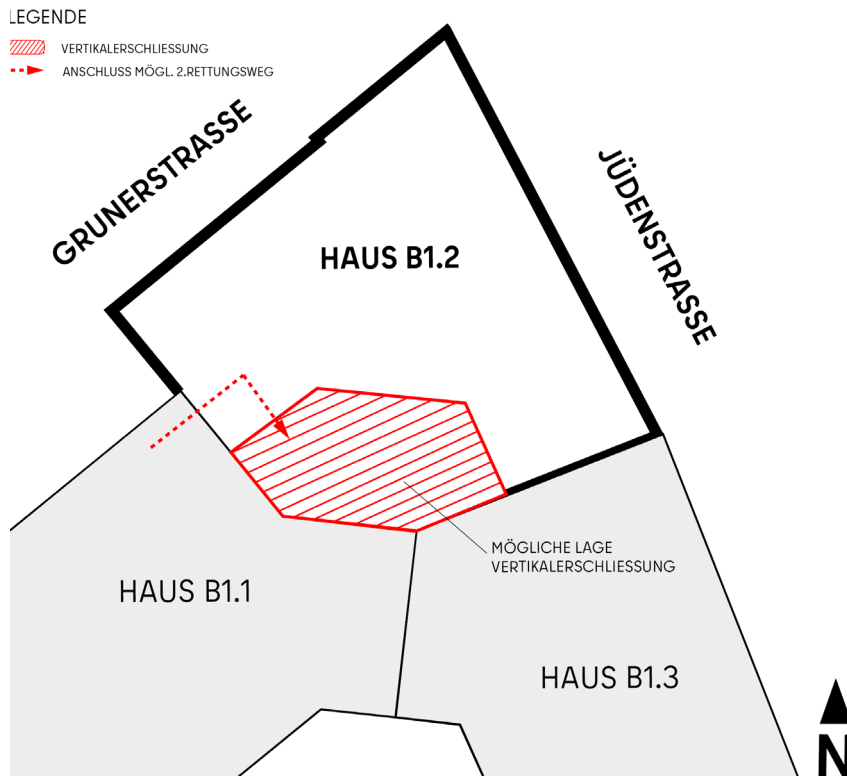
Schematischer Grundriss Regelgeschoss Büro
